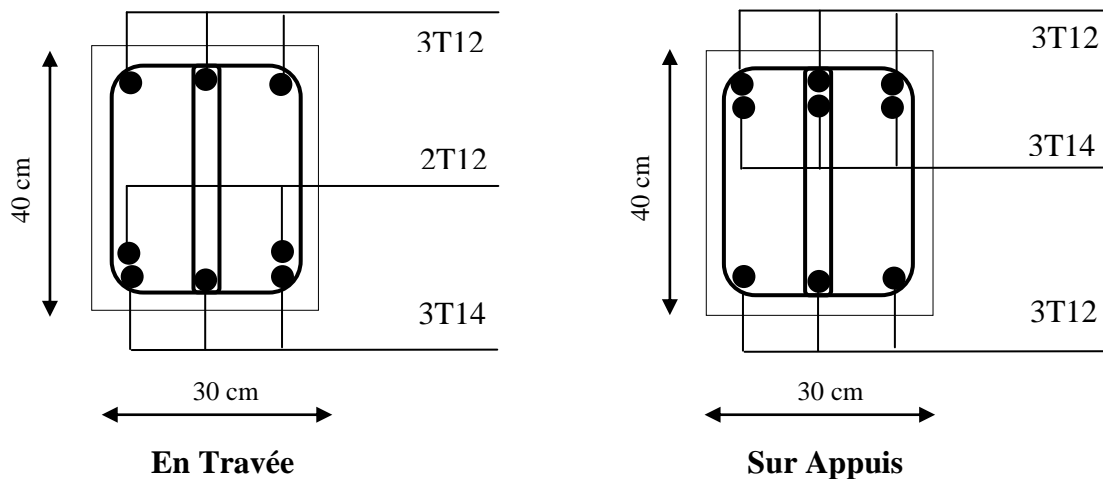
Schéma de ferrailage d'une poutre secondaire (Terrasse)
